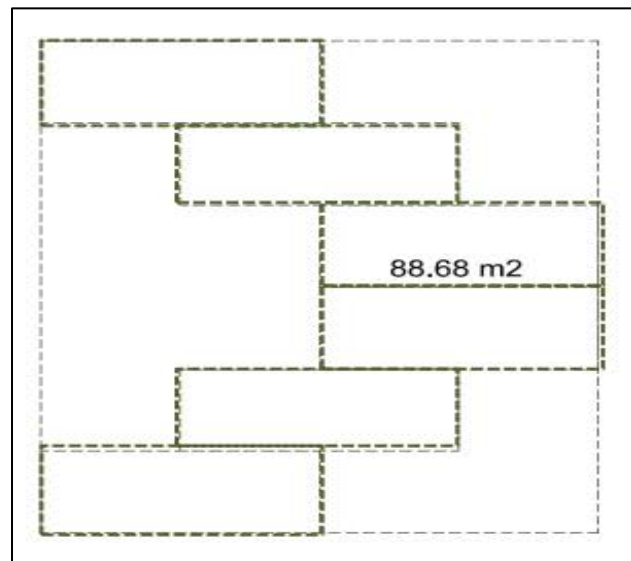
Plano distribución de contenedores diseño planta de proceso deshidratado
